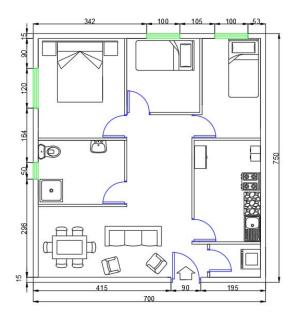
Planta de departamento propuesto, diseñada en AutoCAD. Fuente: Elaboración propia.
